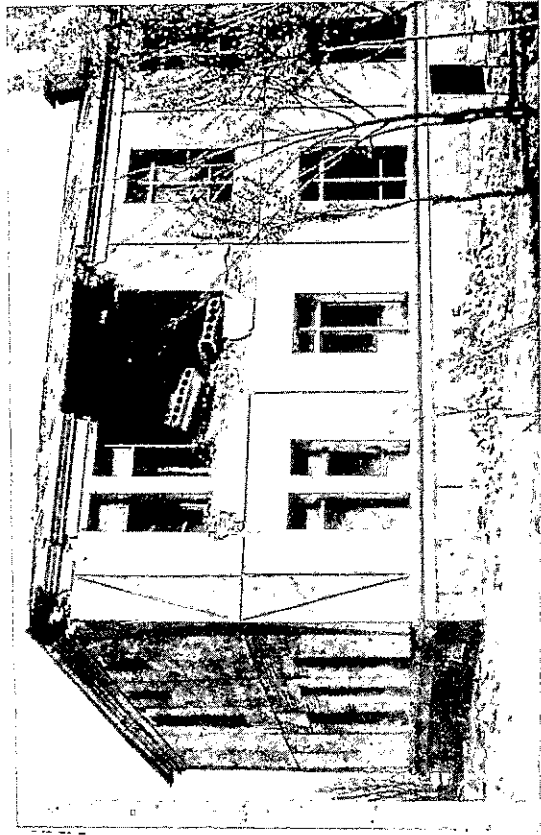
Разрушение главного корпуса поселковой больницы (здесь и далее фото А. Джураева)
